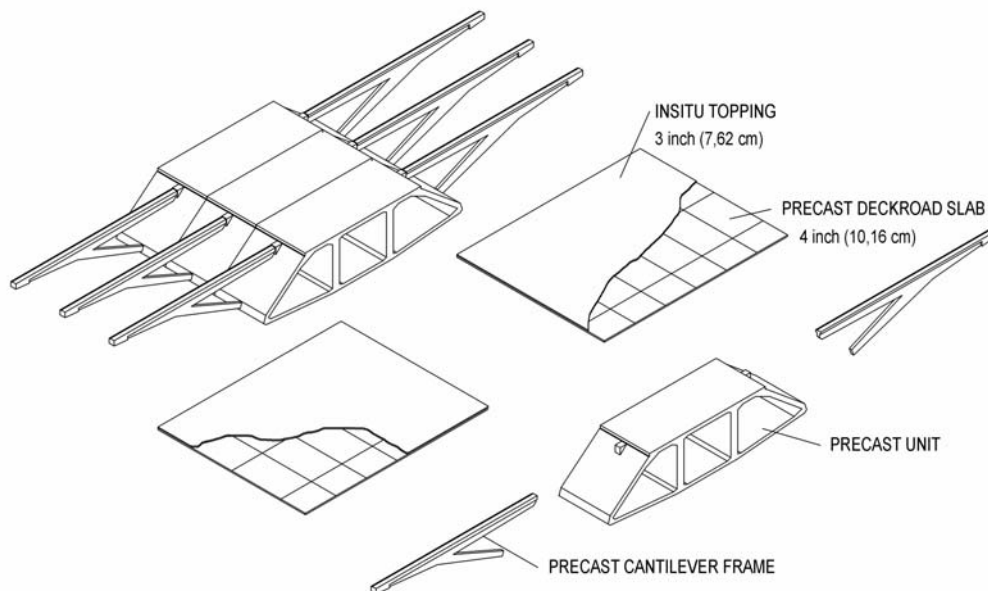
Konstruktion der Spannbeton-Vorlandbrücke
